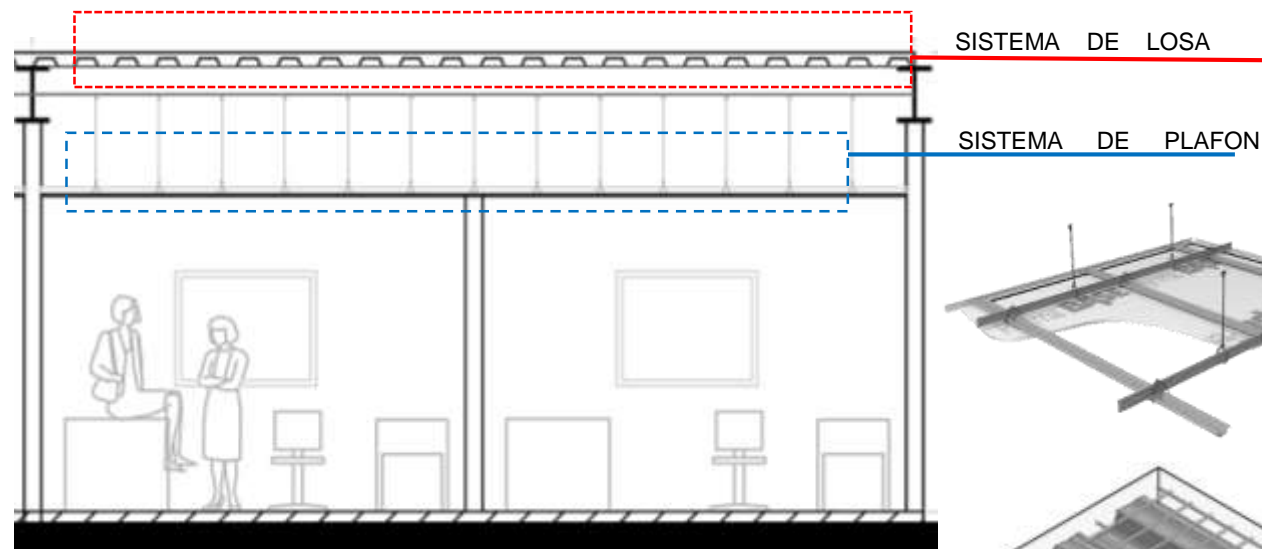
Sistema de losa acero y plafón falso visto en sección del proyecto, Elaboración propia.
